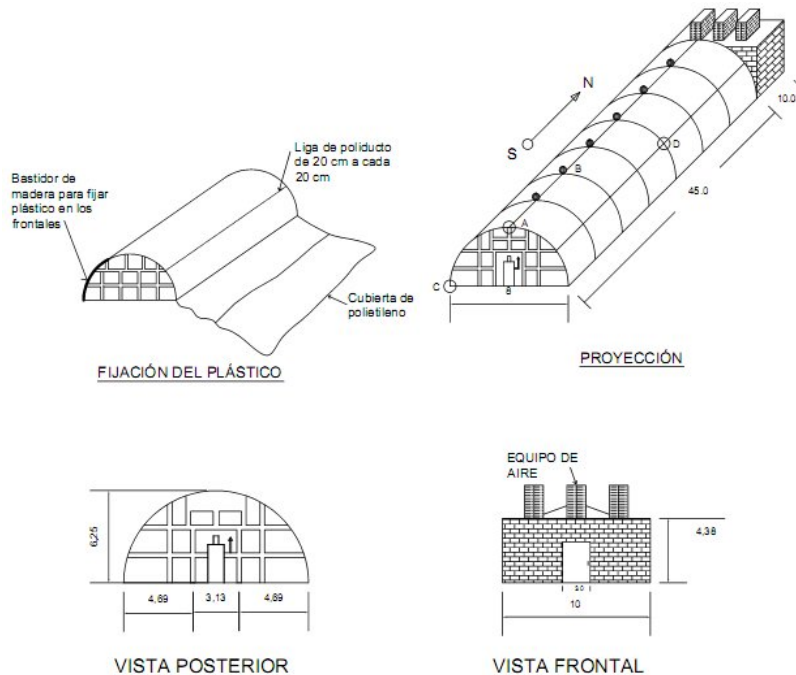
Detalles de construcción para un invernadero tubular.
